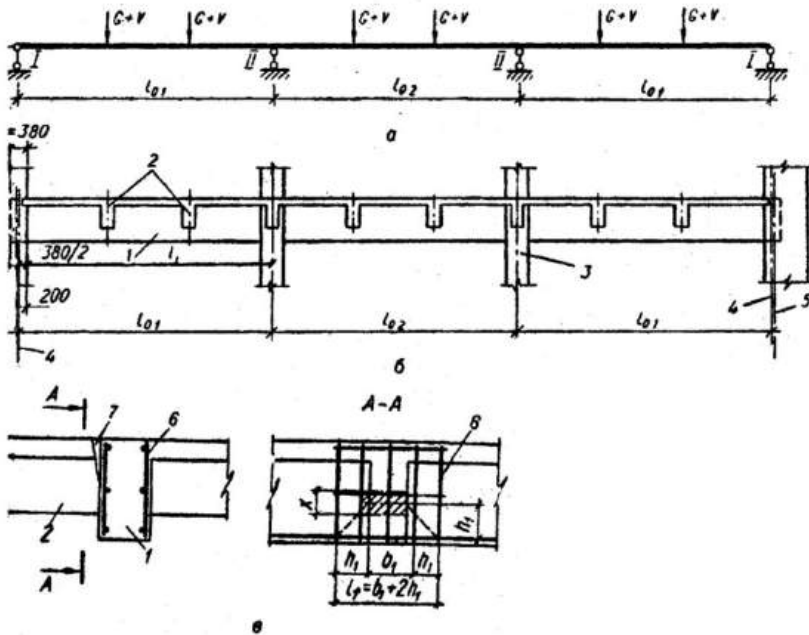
До розрахунку головних балок: а – розрахункова схема; б – розрахункові прольоти; в – схема можливого тріщиноутворення та армування в зоні прилягання другорядної балки до головної; 1 – головна балка; 2 – другорядні балки; 3 – колони; 4 – вісь опори балки; 5 – прив'язувальна вісь; б – додаткові каркаси або хомути; 7 – тріщина; x – висота стиснутої зони на опорі другорядної балки (штриховою лінією показано зону відриву)
